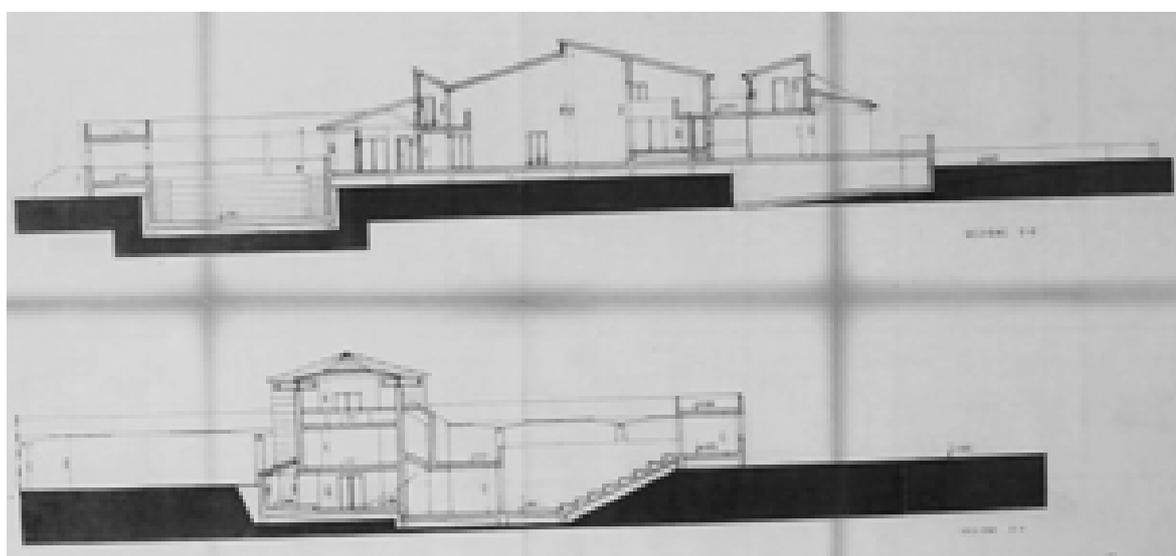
Sezioni CC-DD, stato futuro – 26/07/1994 (AABS-64_692)
